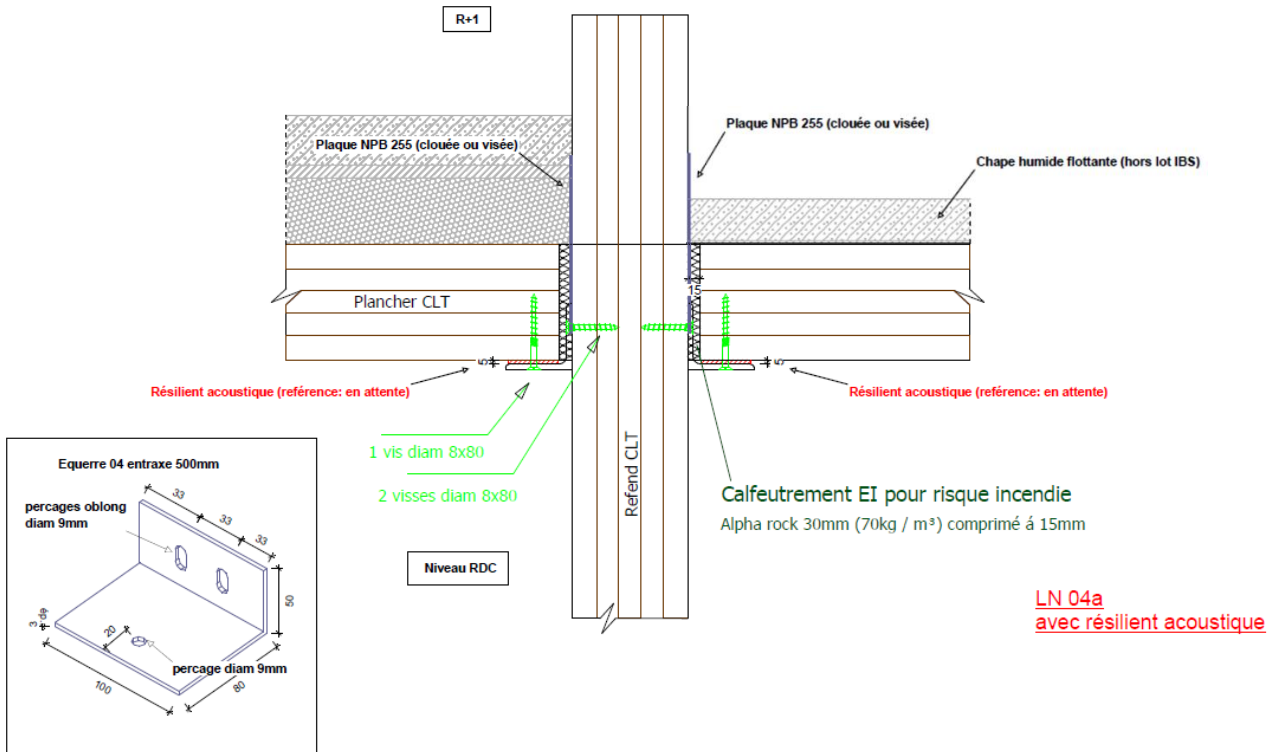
Liaison mur CLT – plancher interrompu LN04a avec résiliant
